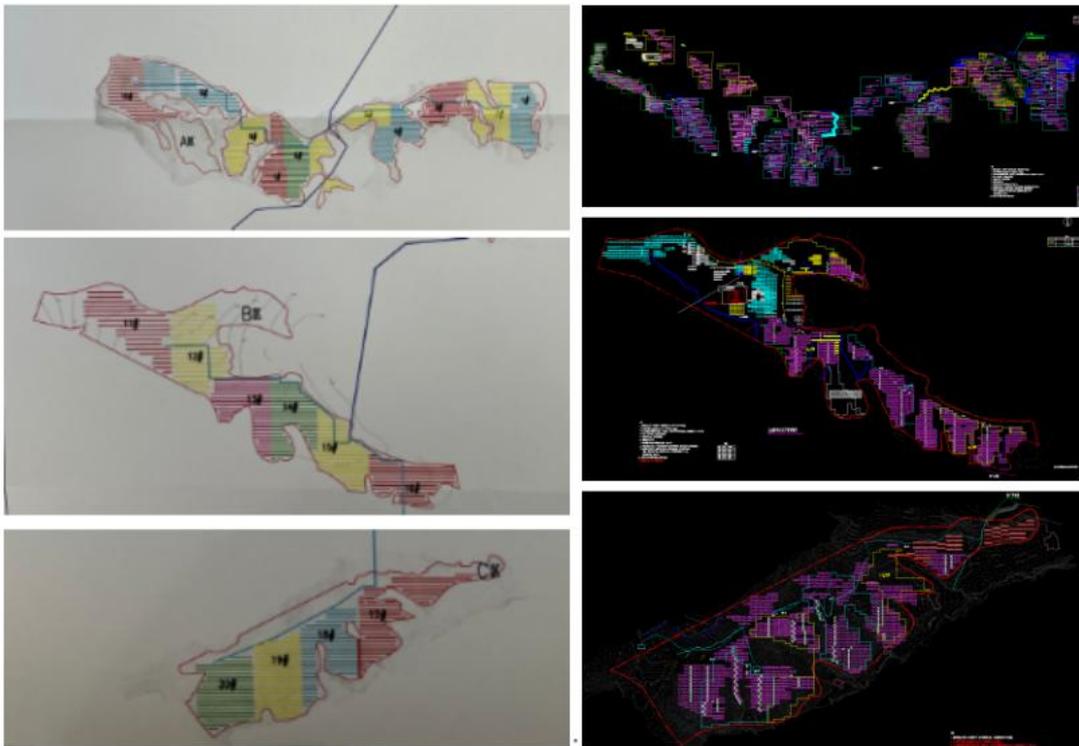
本项目平面布置对比图（左侧为环评内容，右侧为实际布置情况）
